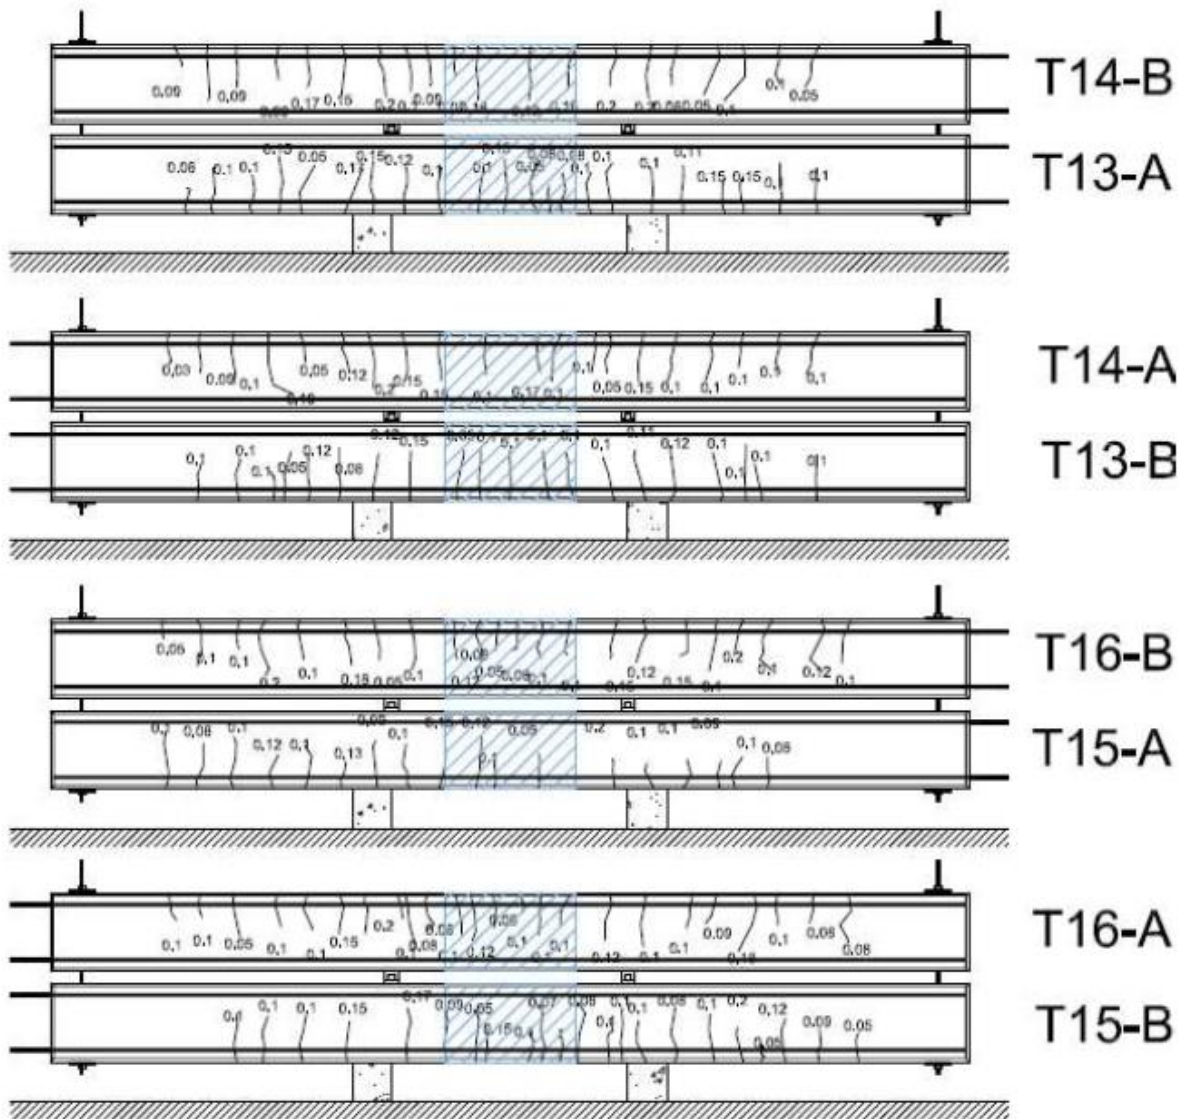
Esquema de grietas de traves T13 a T16 de CR con AR longitudinal a tensión de 13 mm de diámetro.
